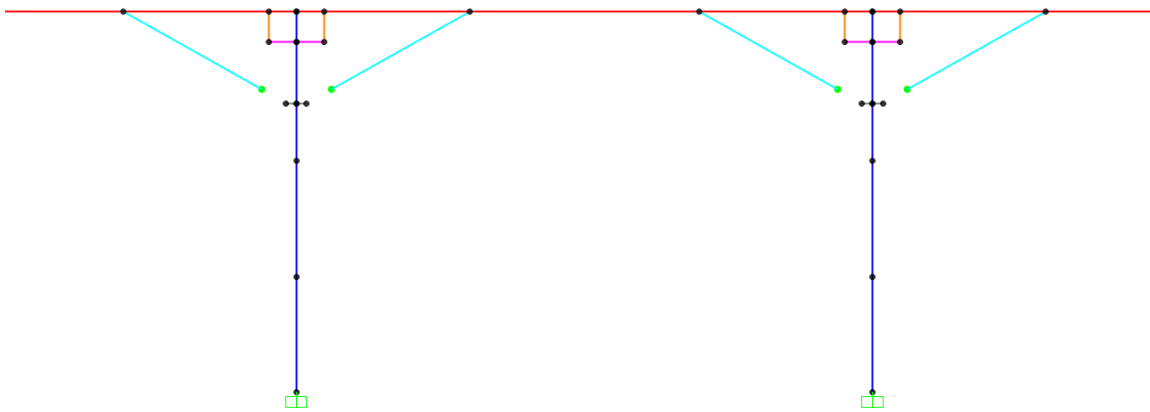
Modelo da estrutura no plano longitudinal
